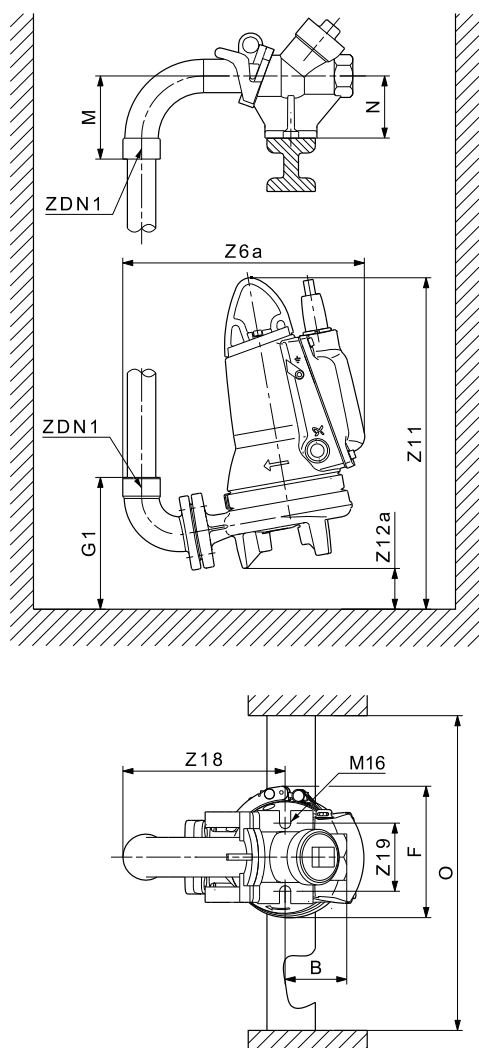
Volně stojící instalace s prodlouženými nožkami
